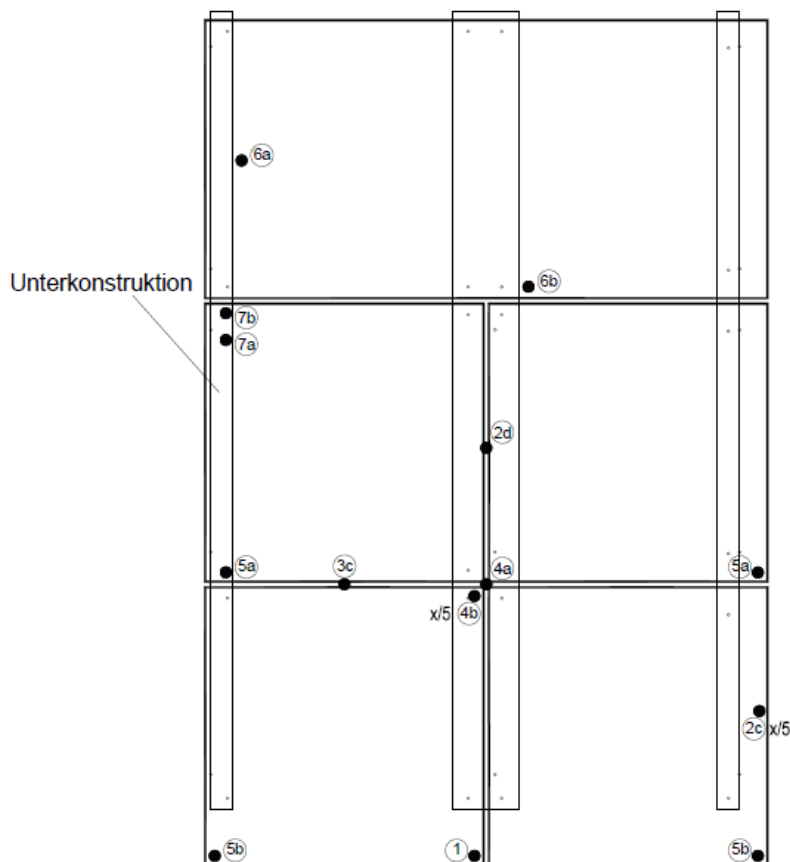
Beschussorte für Faserzementelemente als vorgehängtes Bauteil
